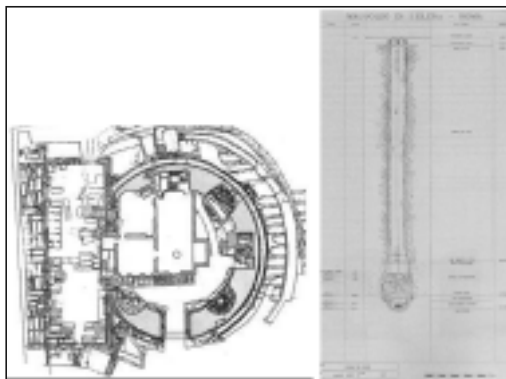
Roma, S. Elena, pozzo al centro del mausoleo, pianta e sezione (VENDITELLI 2012).
